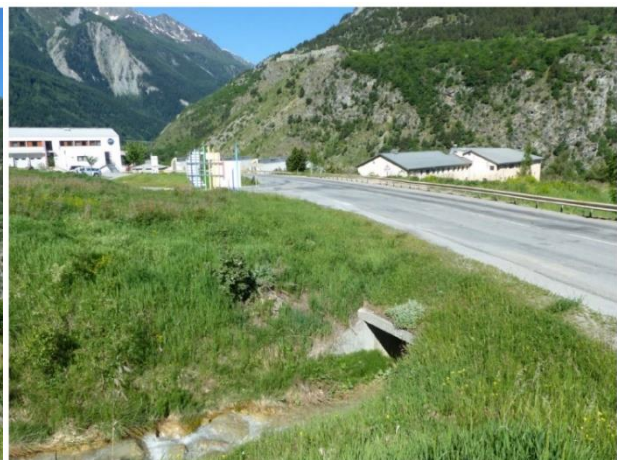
vue sur le bas du secteur de projet et le ruisseau sous la RD216
